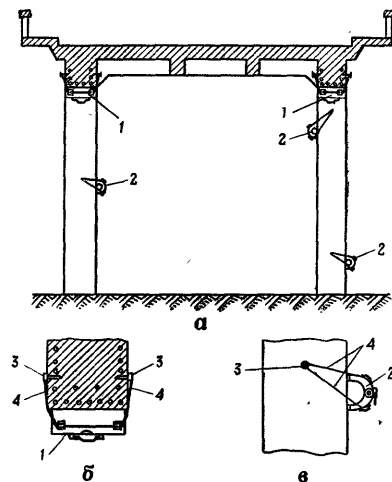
Подрывание железобетонного путепровода удлиненными кумулятивными зарядами КЗУ: а — расположение зарядов на стойках и балках; б — крепление заряда на балке; в — крепление заряда на стойке; 1 и 2 — заряды; 3 — штыри (дюбели), забитые выстрелами из строительного пистолета; 4 — проволока
